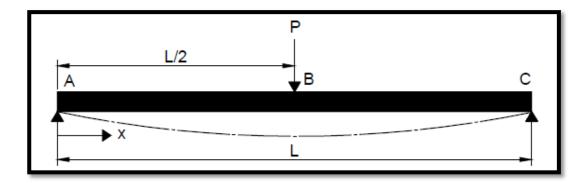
Deflexión en vigas simplemente apoyadas
